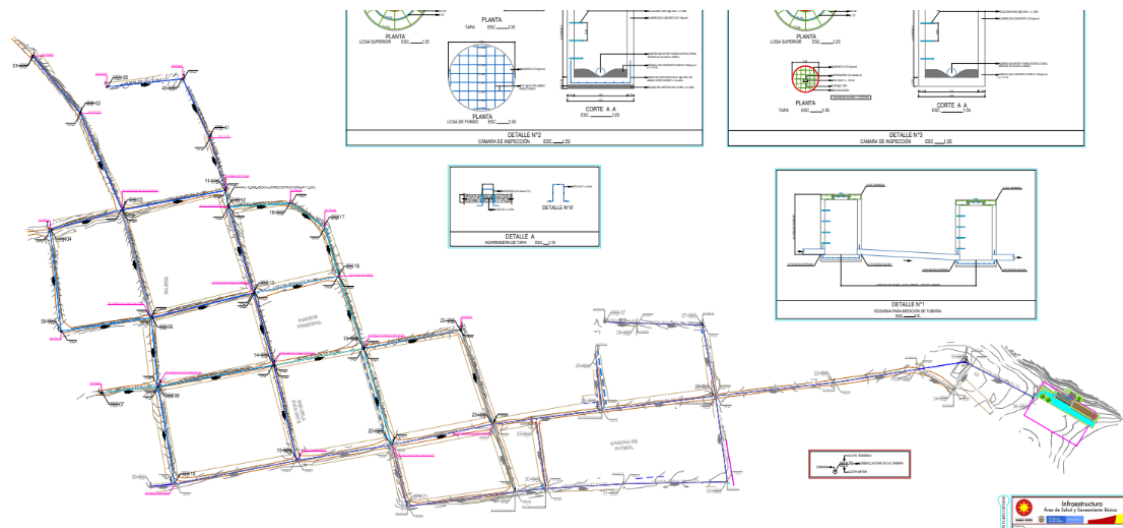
Plano planta general alcantarillado sanitario segunda etapa
